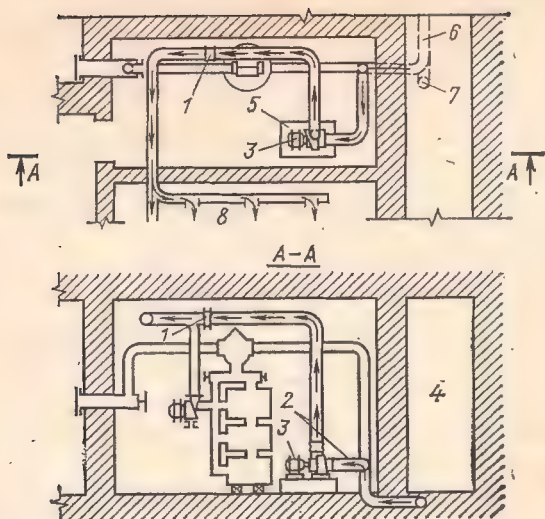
Вариант установки дополнительного вентилятора в фильтровентиляционной камере:
